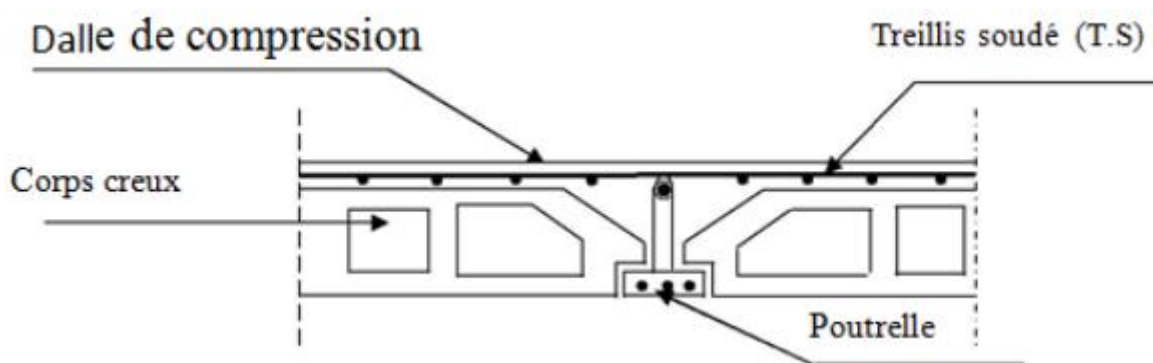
Coupe transversale d'un plancher en corps creux.
